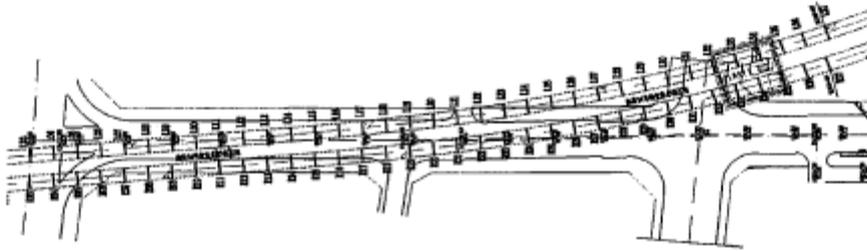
沙湖路市政工程与地铁线路位置关系平面图
